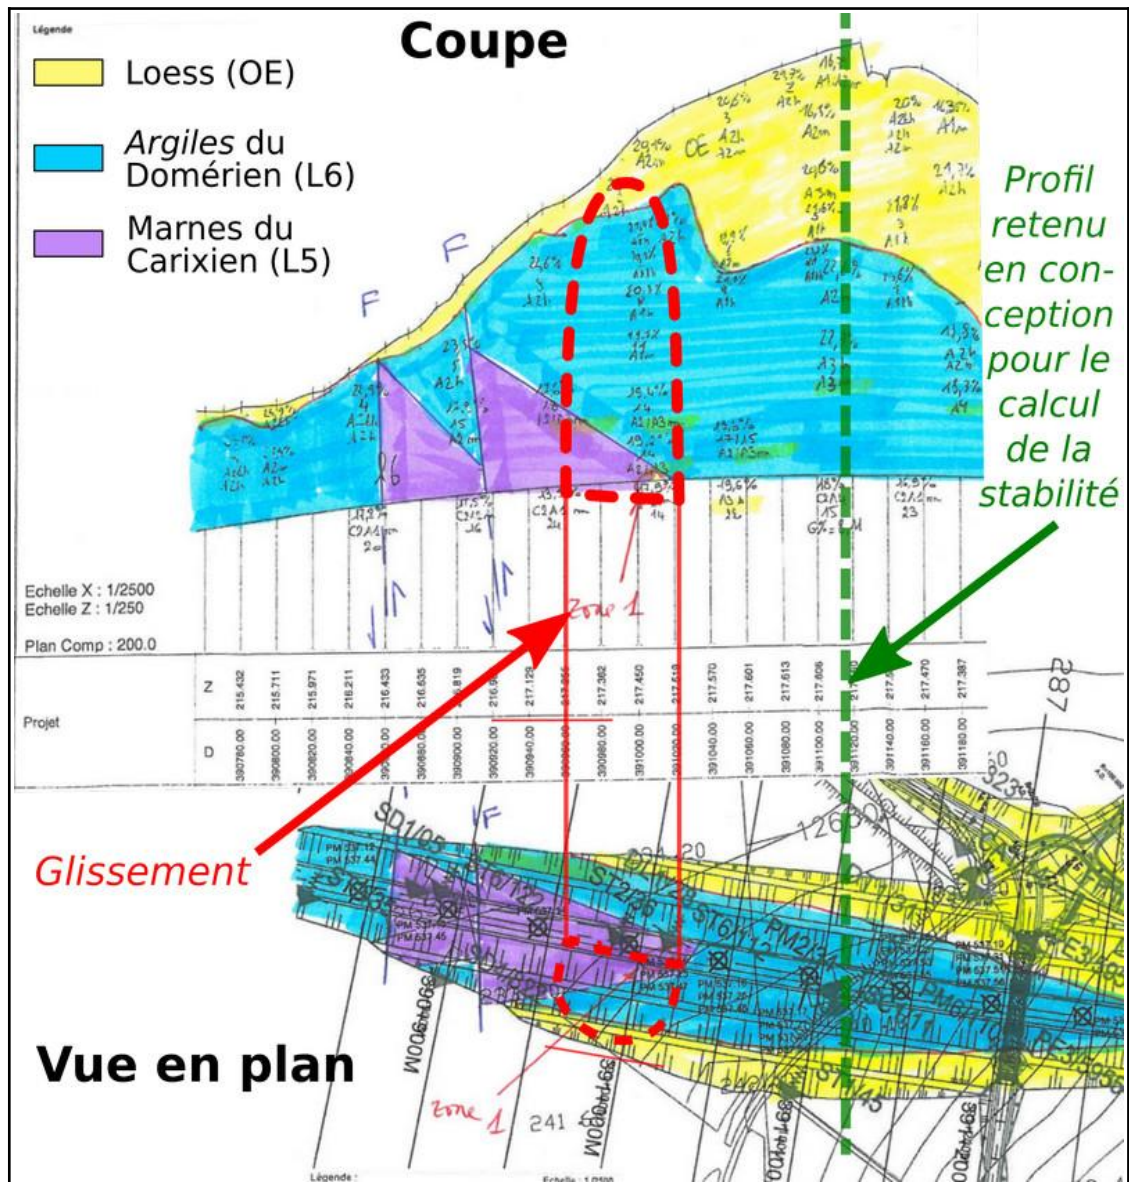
maquette géologique au droit du DB 537, en coupe et en vue en plan
